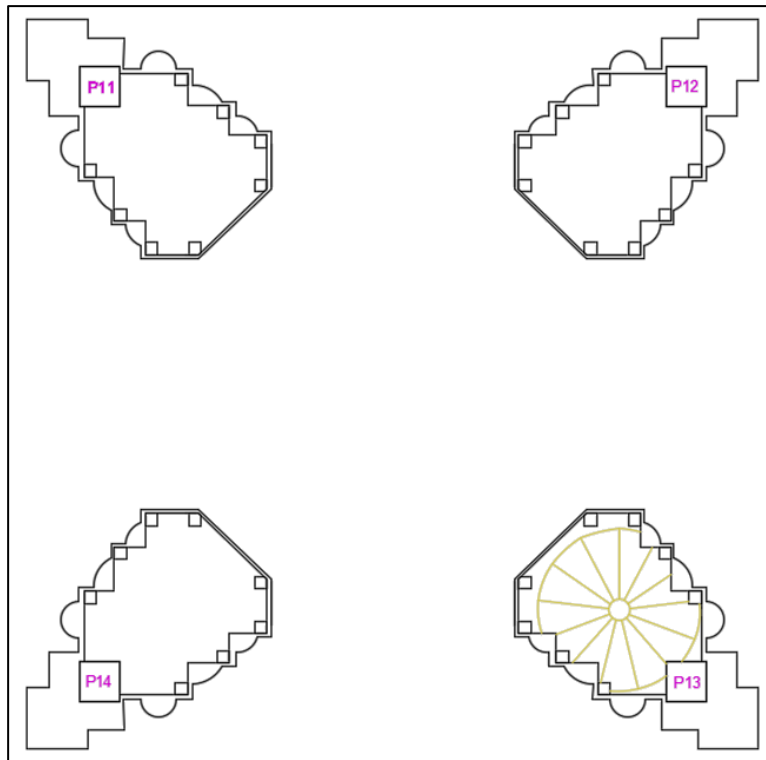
9 Planta estructura primer nivel Torre del Reloj de Iquique
